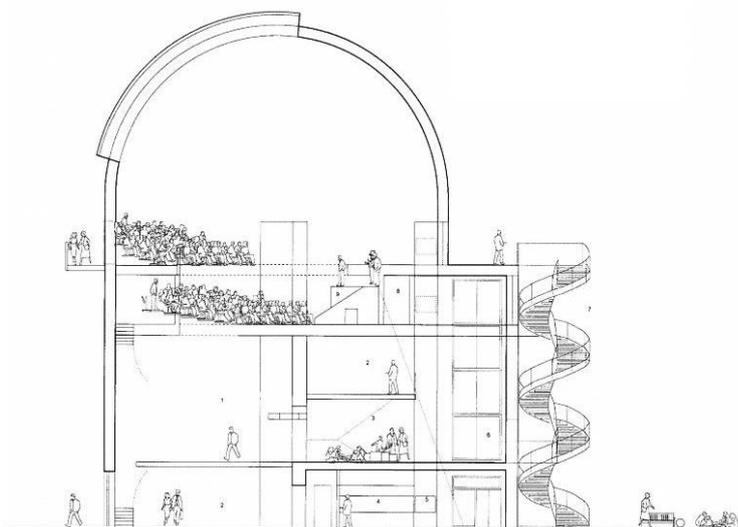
Propuesta de cambio de uso del Telescopio Isaac Newton. Fine Architects.
